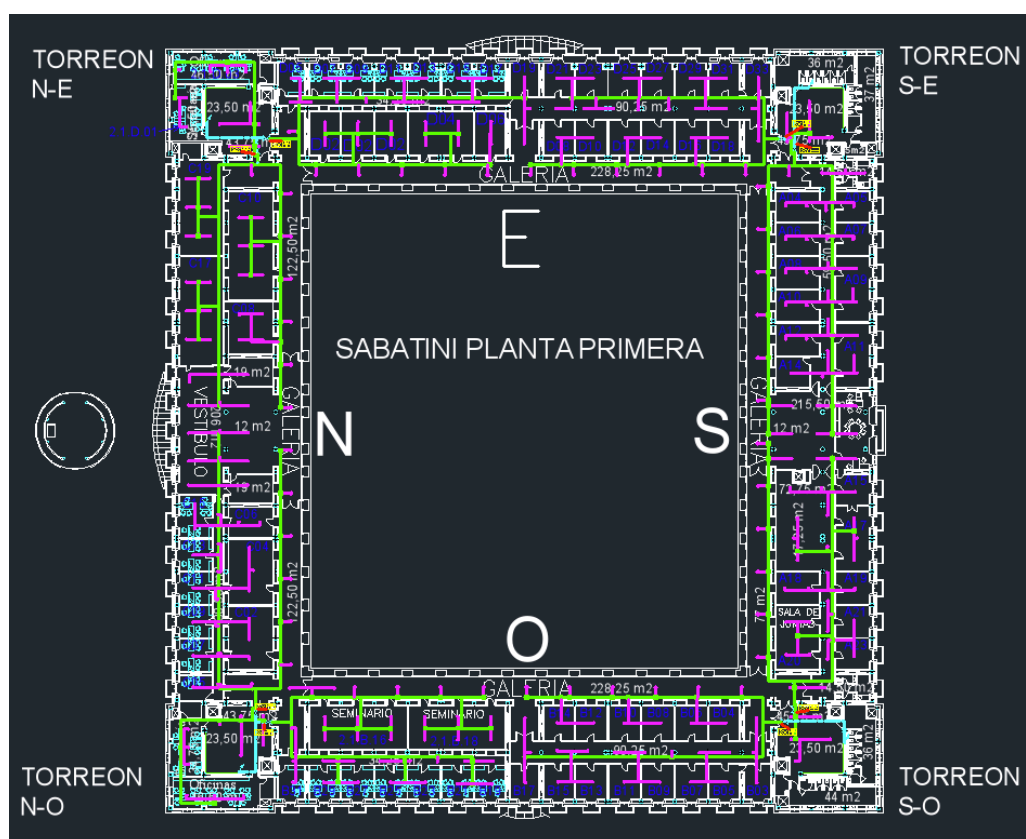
Vista en planta de la planta primera con la distribución del sistema – AutoCAD
